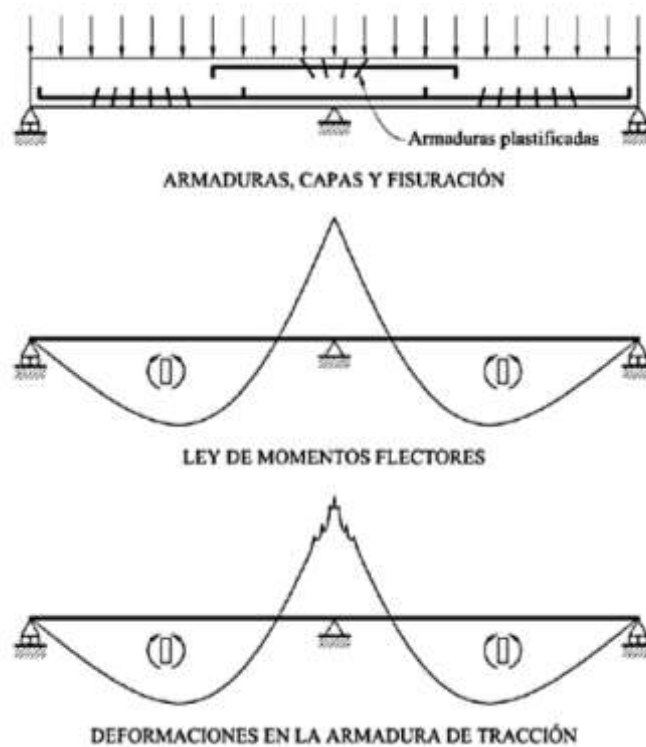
Rótula plástica sobre el apoyo central de una viga continua. (Nonlinear behavior of reinforced concrete structures, Antonio Mari, 2017).
